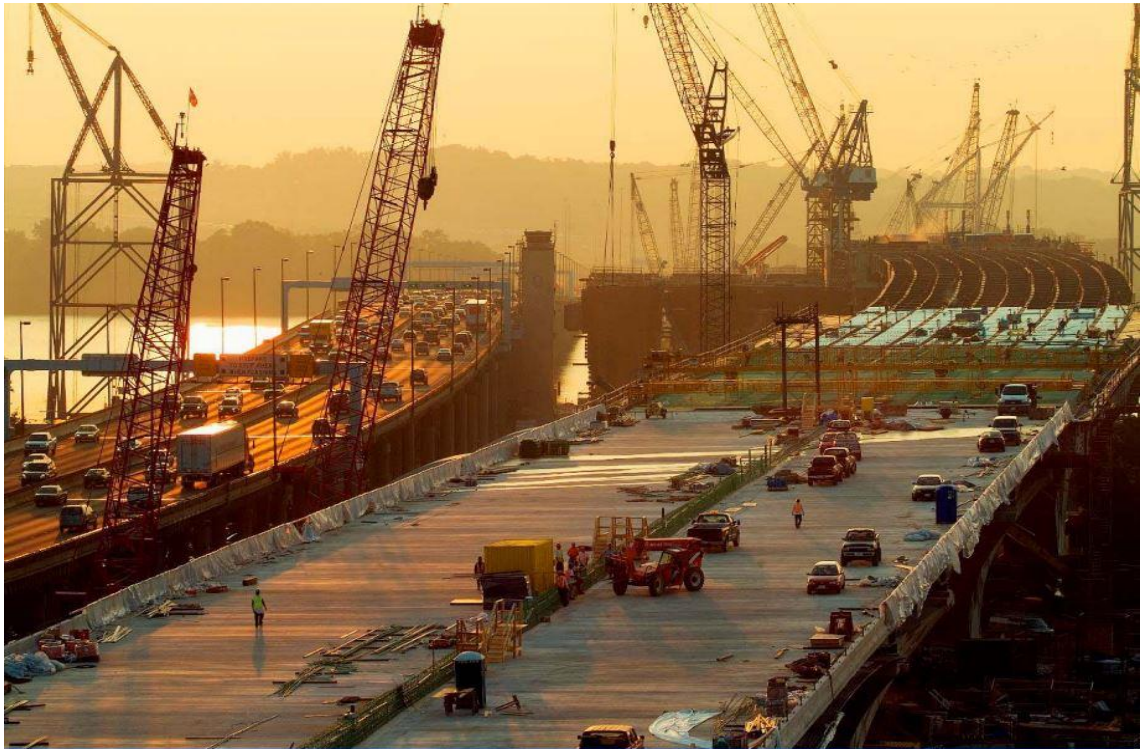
48 Woodrow Wilson Memorial Bridge 橋版施工
